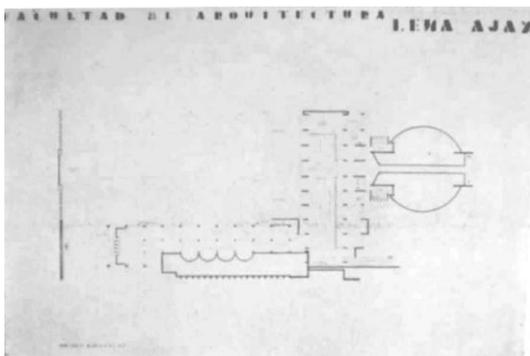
Proyecto ganador del Concurso para la Facultad de Arquitectura. Planta Baja
